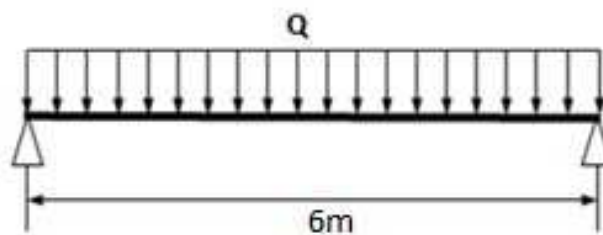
schéma statique de la poutre de roulement sur deux appuis
